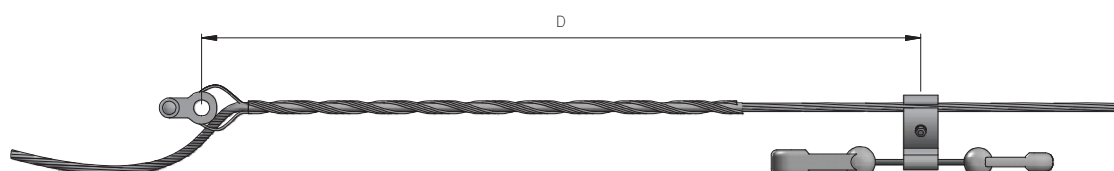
APLICAÇÃO EM ESTRUTURAS DE ANCORAGEM COM ALÇA PREFORMADA
